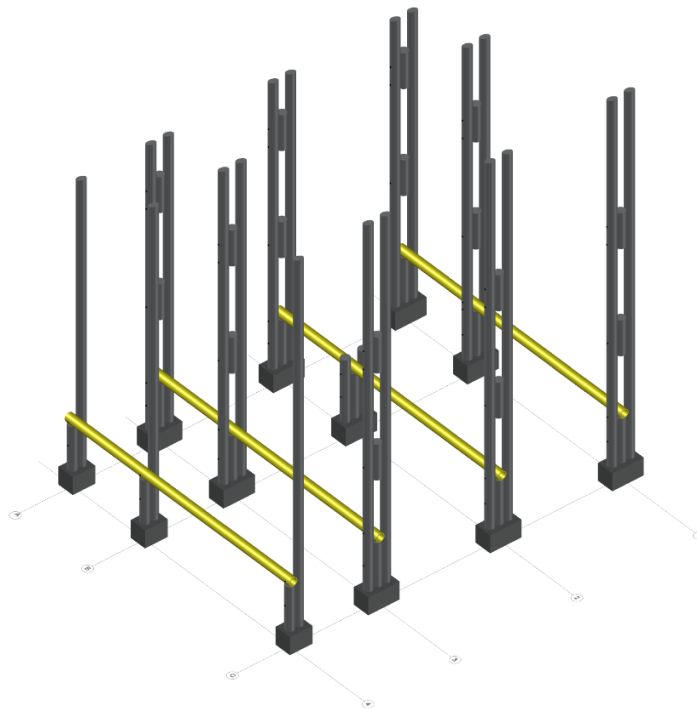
Vigas de entepiso de la vivienda de emergencia. Fuente: Elaboración Propia
